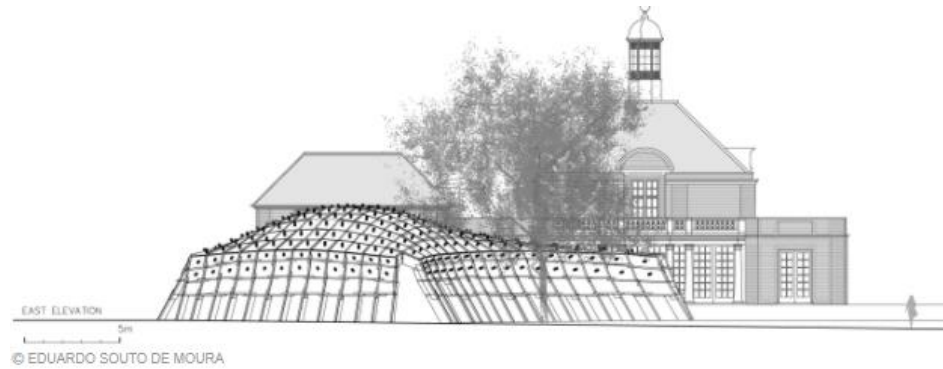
Elevação leste. Fonte: DIVISARE (2019) adaptado pela autora (2021).
